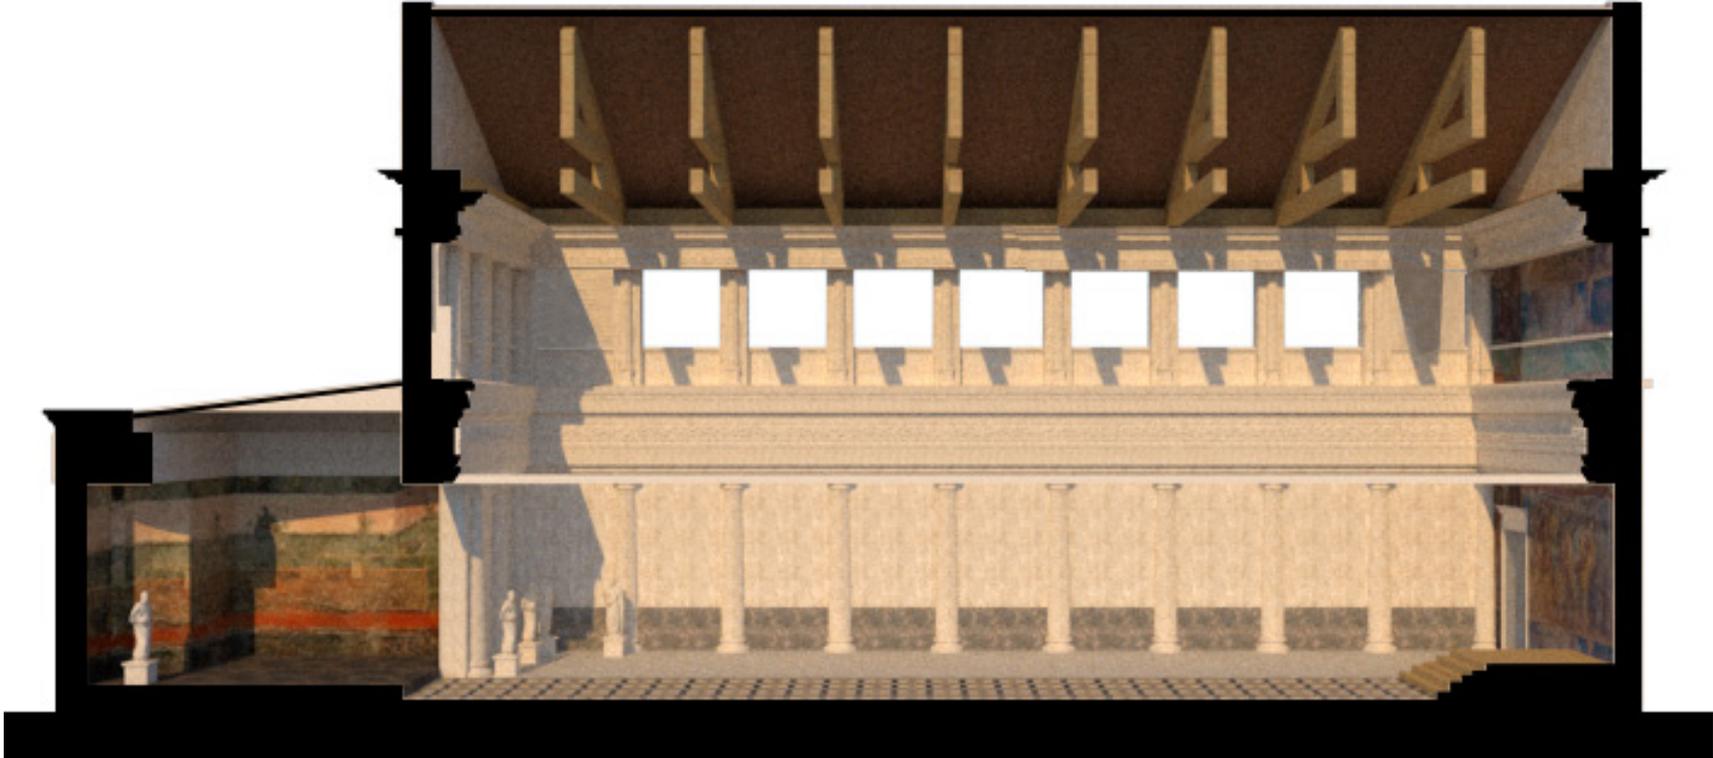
Sección longitudinal (Autoría propia, 2021)
